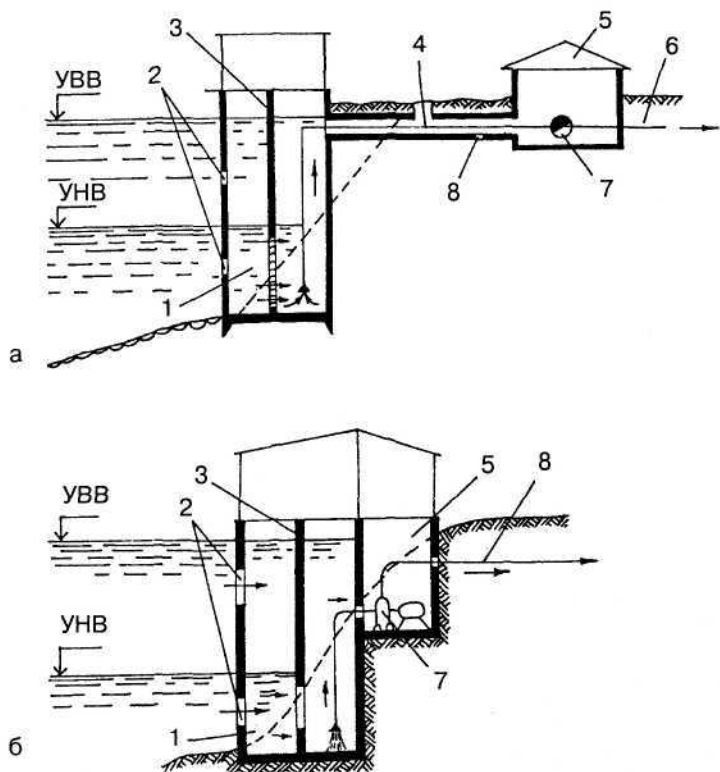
Схемы речных водозаборов: а — берегового раздельного; б — берегового совмещенного: 1 — береговой колодец; 2 — водоприемные окна с решетками; 3 — перегородка с сетками; 4 — всасывающие трубы; 5 — насосная станция; 6 — напорные водоводы; 7 — насосы; 8 — галерея для размещения всасывающих труб
